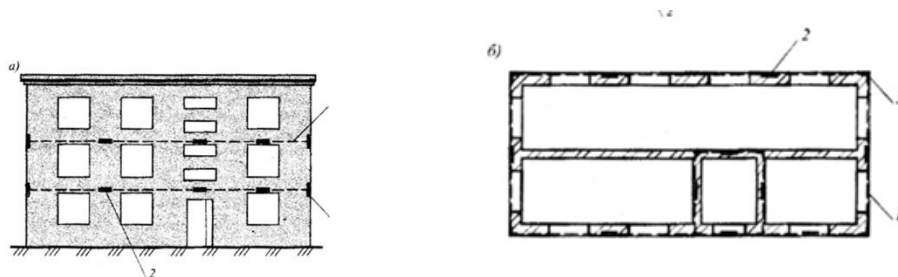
Усиление стен стальными тяжами, устанавливаемыми в стенах:
